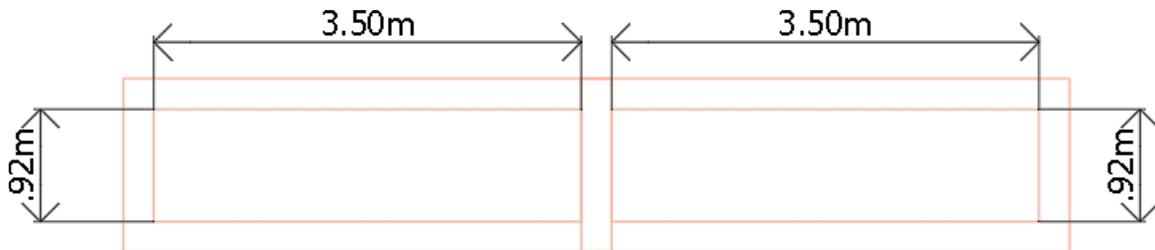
Sección Transversal Rediseños de Boxculvert 2
